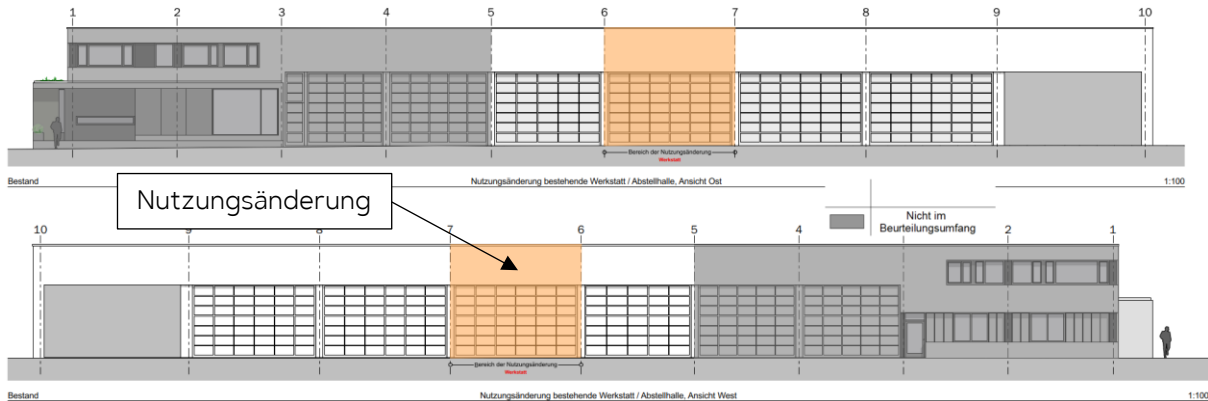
Betrachtungsumfang Bestandsgebäude
